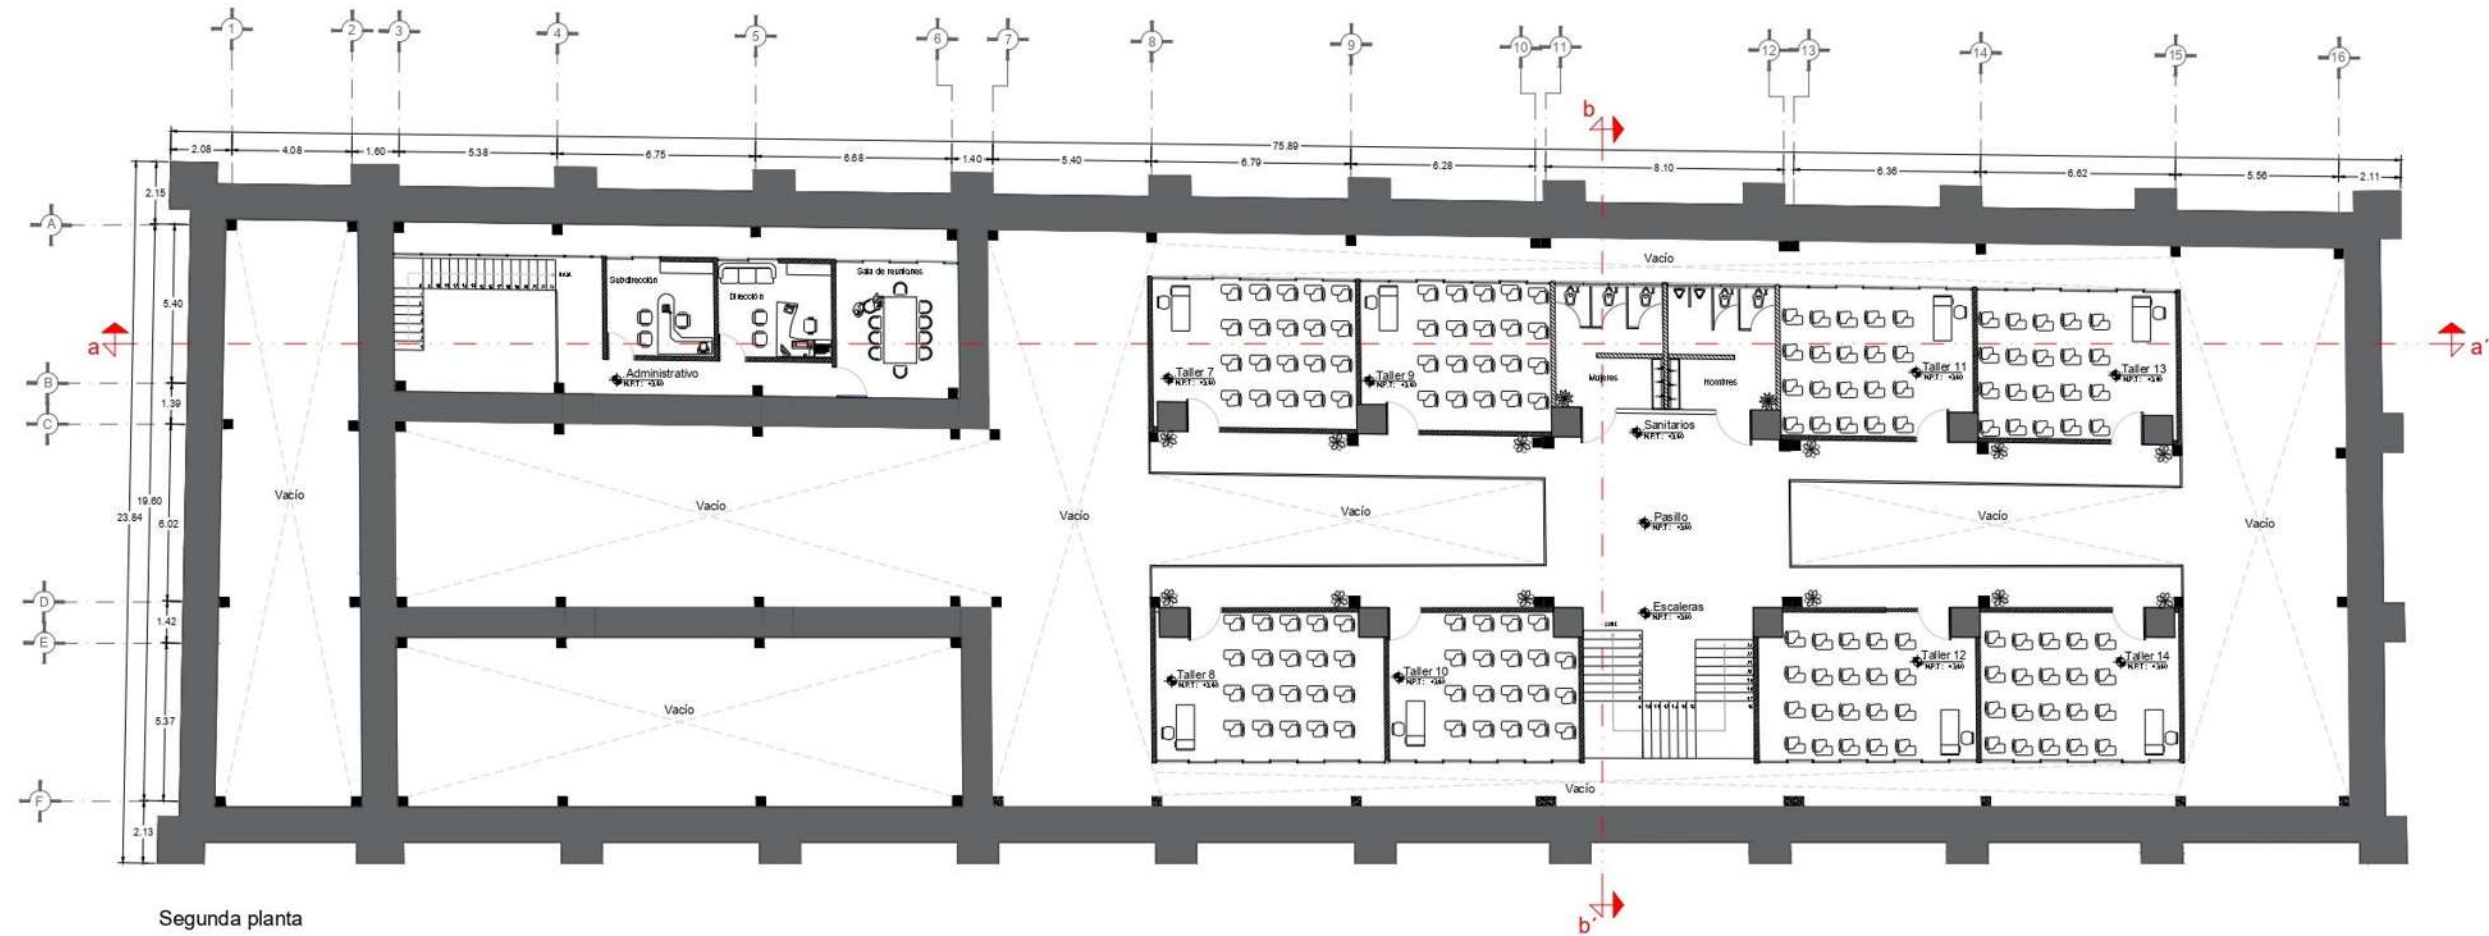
Plano arquitectónico 1. Fuente: Elaboración propia.
